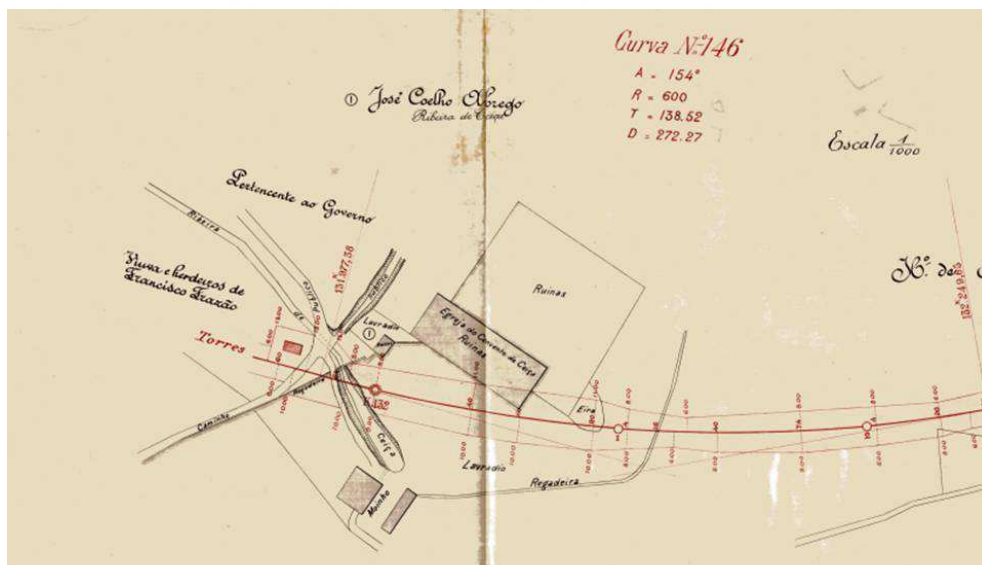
Pormenor da Planta de Implantação do Troço da Linha do Oeste, na zona do Mosteiro de Seiça (datada de 29 Abril de 1886). Fundo arquivístico da Direcção Fiscal de Exploração dos Caminhos de Ferro – Centro Nacional de Documentação Ferroviária
